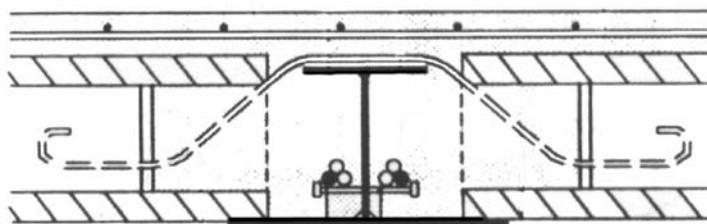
IFB Viga integrada à laje (“*integrated floor beam*”)
